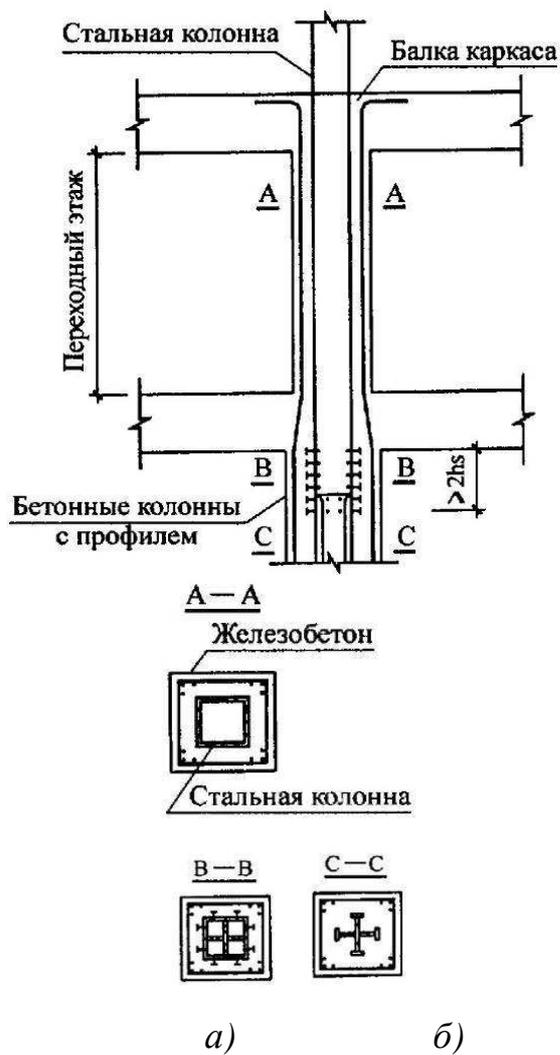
Монтажный узел стыковки между сталежелезобетонными колоннами со стальным профилем и стальными колоннами. Между соединяемыми по высоте колоннами предусматривается переходный этаж, который должен удовлетворять условиям: 1) стальной профиль жесткого армирования сталежелезобетонной колонны рассчитывается как стальная колонна; 2) стальные профили переходного этажа крепятся на болтовых соединениях с шагом по высоте  $l \geq 200\text{мм}$  и защитным слоем бетона  $a \geq 50\text{мм}$ ; 3) соединение крестообразных и прямоугольных стальных сечений колонн осуществлять с совмещением стенок
